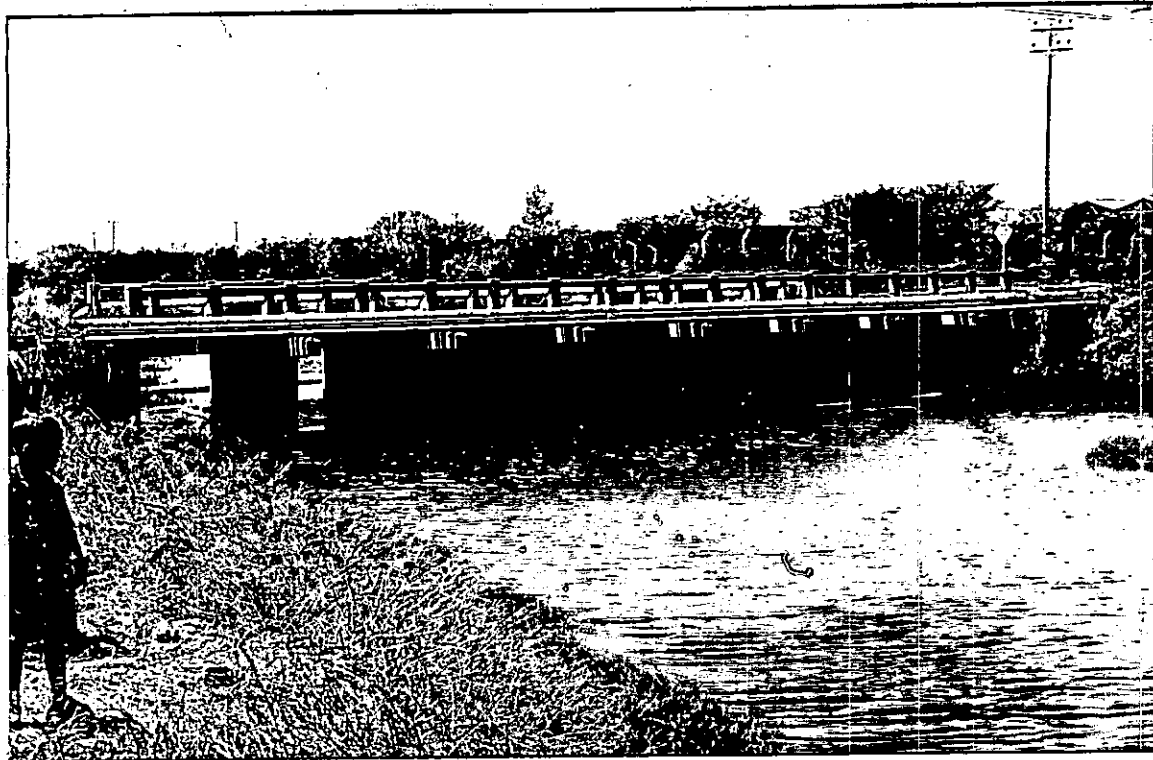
Arroyo Casimiro. Entrada al culvert sobre la via Mamonal.
